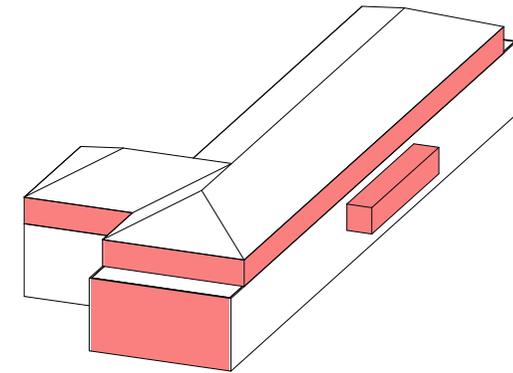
An der Nordfassade wurde eine neue Terrasse für den Veranstaltungssaal angebracht.
